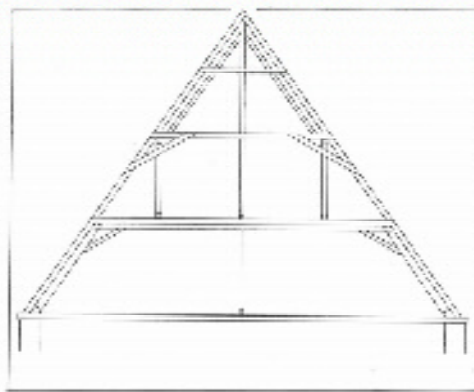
Dreistöckiges Kehlbalckendach mit doppeltem liegendem Stuhl und doppeltem stehendem Stuhl und Hängewerk
